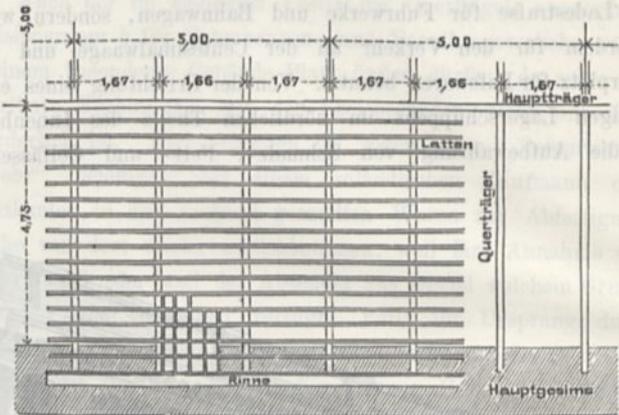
Grundriß des Dachgespärres auf dem Niederlagegebäude.
